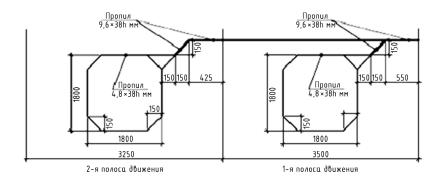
Схема выполнения пропилов в асфальтобетонном покрытии
